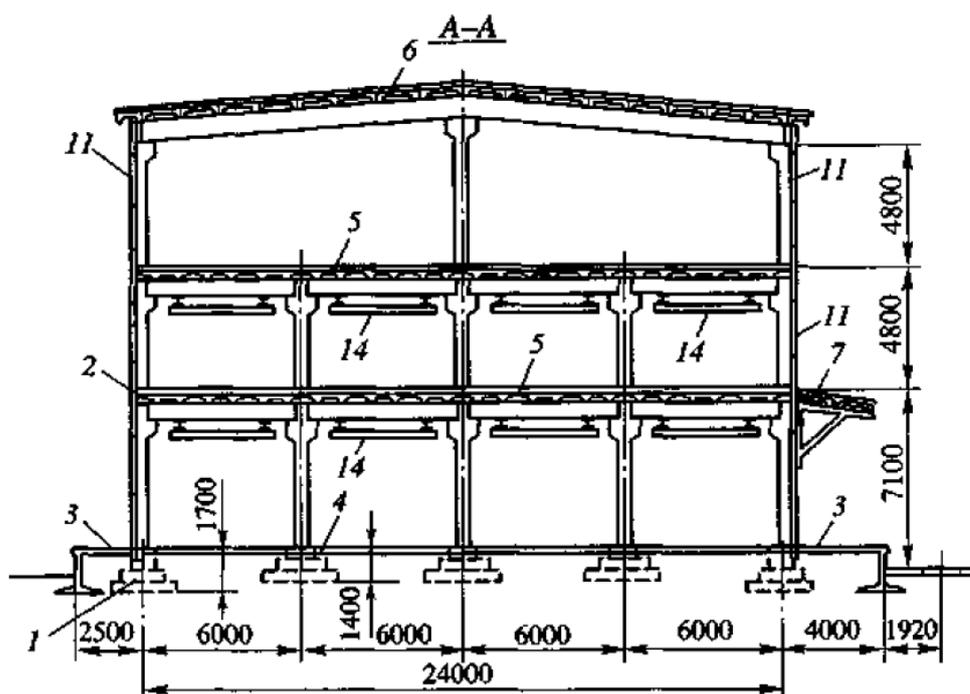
Схема универсального трехэтажного склада железобетонной конструкции:
